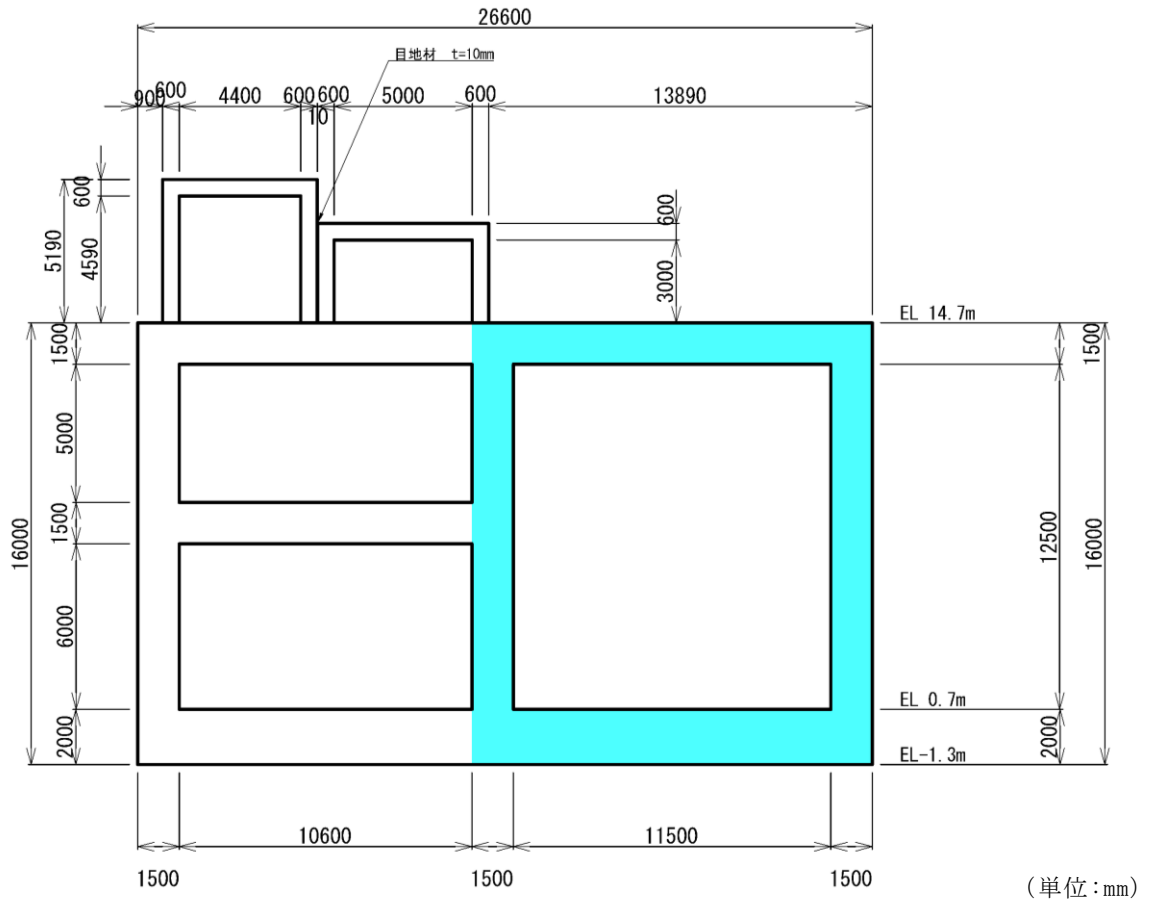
低圧原子炉代替注水ポンプ格納槽 断面図 (A-A 断面)
